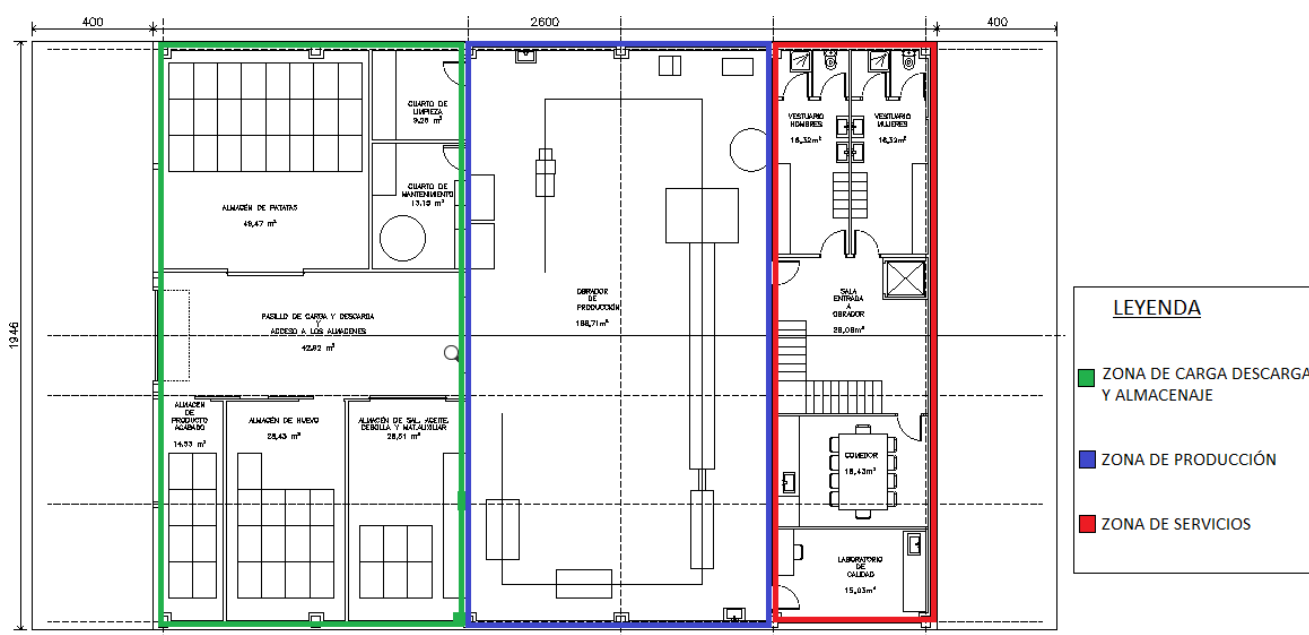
Zonas correspondientes a la planta baja de la nave
